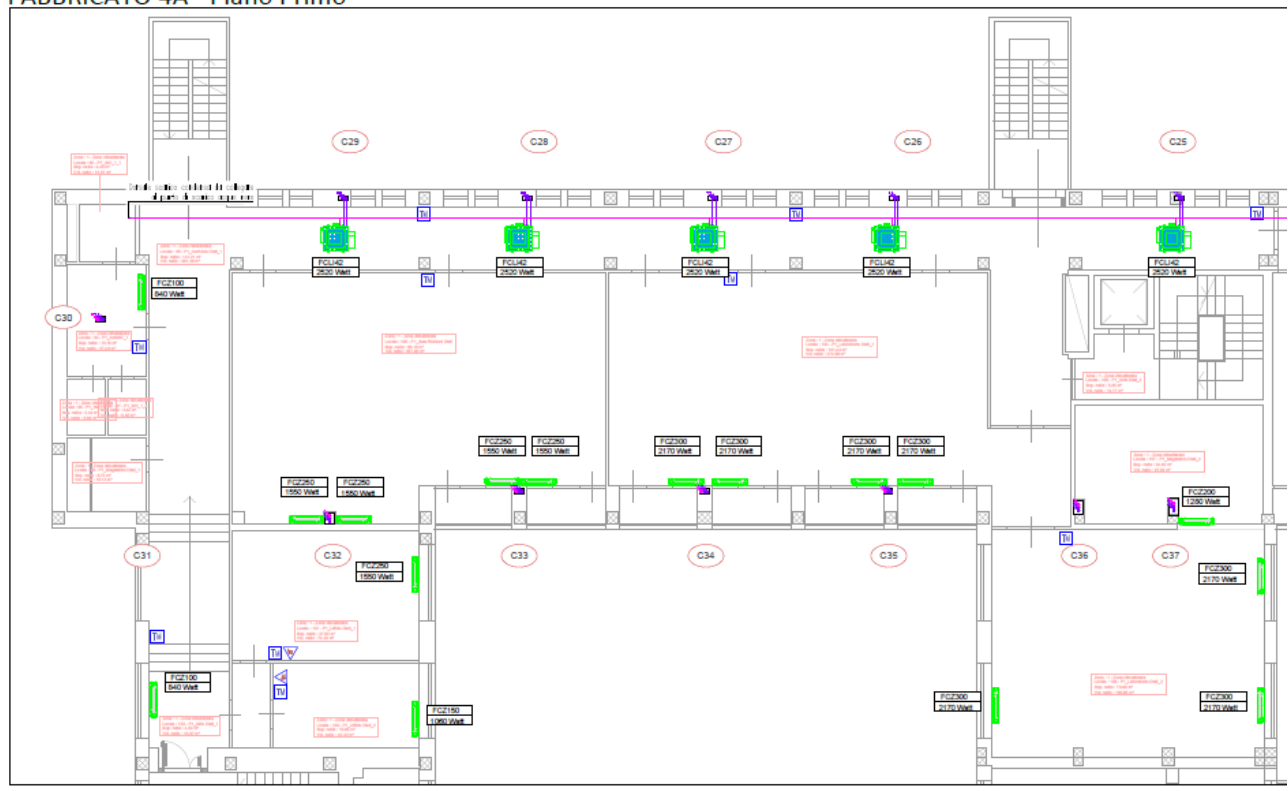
Particolare estratto dalla tavola di progetto relativa al collocamento dei nuovi ventilconvettori a pavimento e a soffitto [5]
